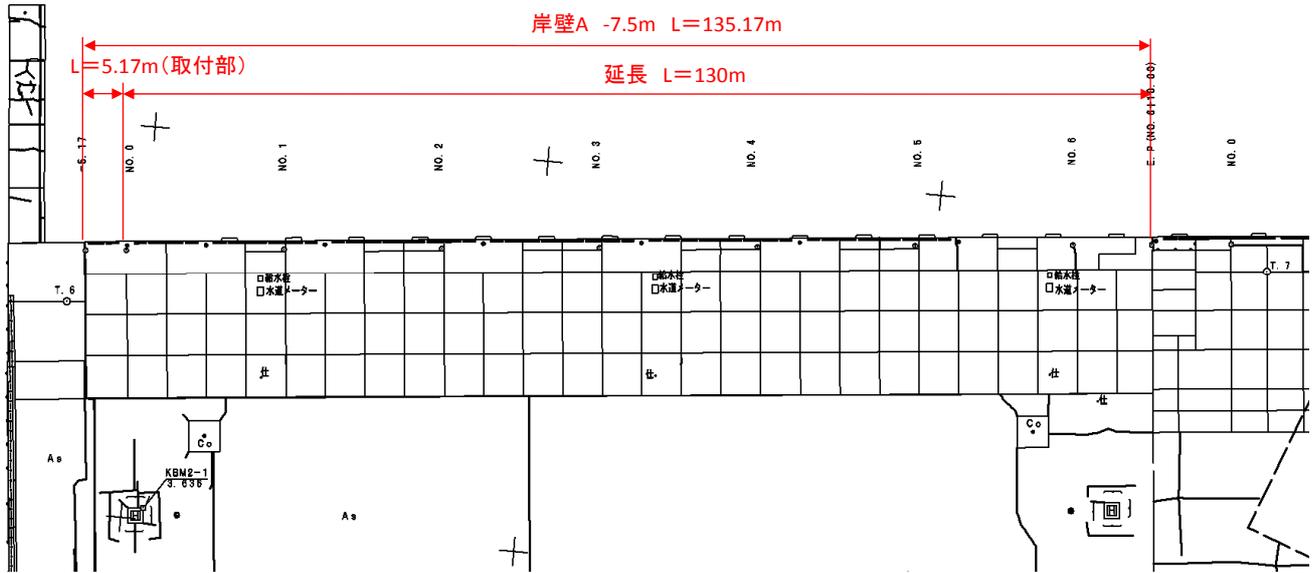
232 No.20 常陸那珂港区_中央ふ頭地区岸壁 (-7.5m) の平面図 (被災前)
